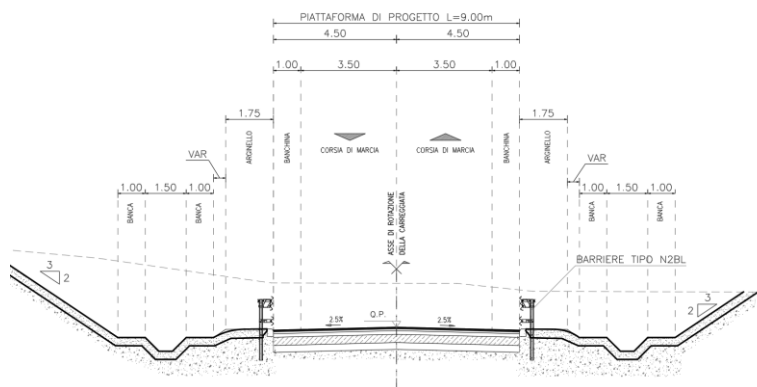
sezione tipo in rilevato per le strade tipo F1
